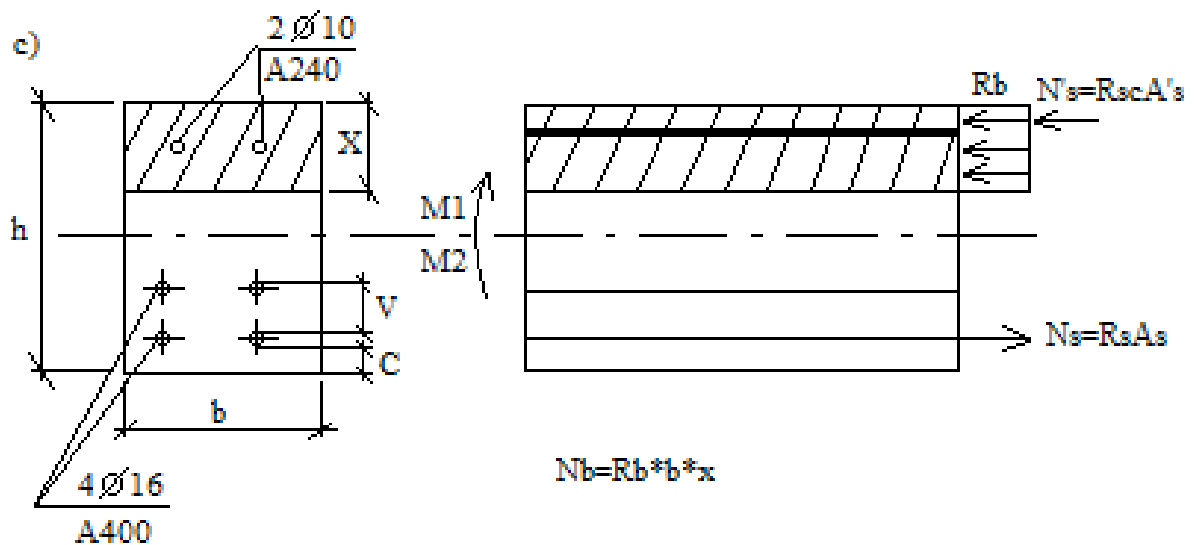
Розрахункова схема залізобетонного ригеля
